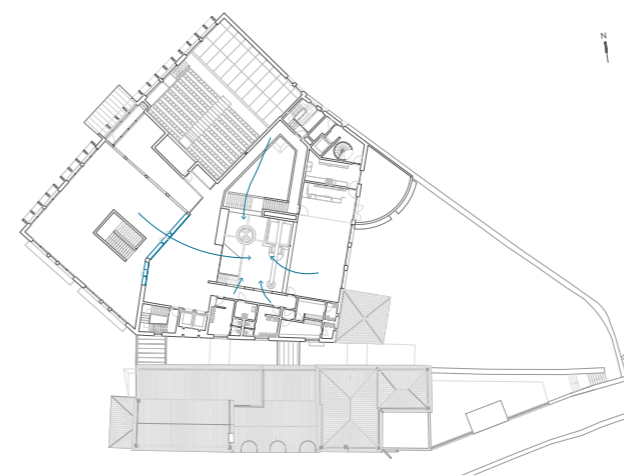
Planta de piso 2 (setas de relações com o espaço central).
